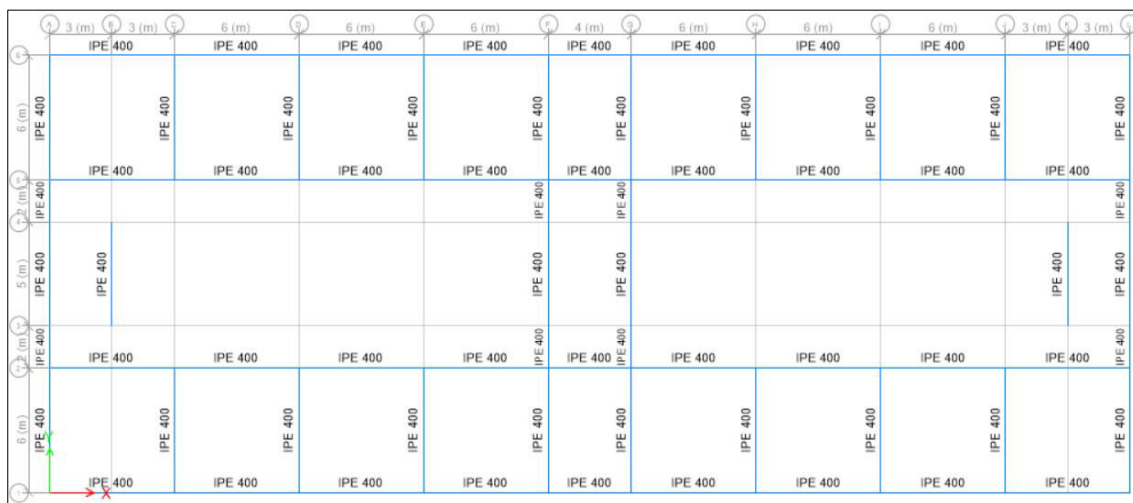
Distribución de vigas principales IPE 400 en losas inferiores.
